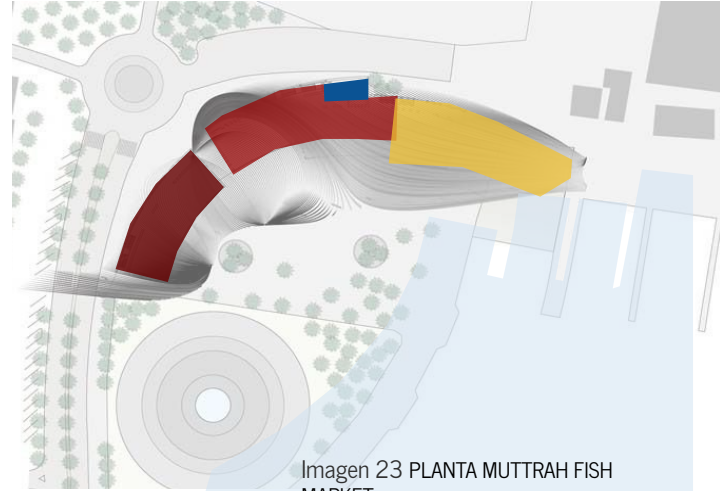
PLANTA MUTTRAH FISH MARKET
